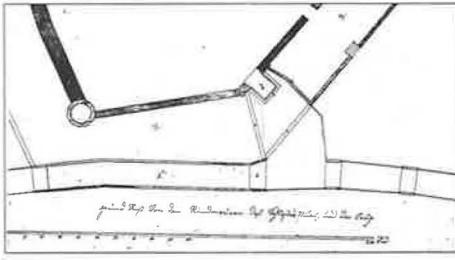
Ausschnitt aus einem Grundrissplan vermutlich Mitte 18. Jahrhundert, Ostseite des Schlosses. In der Bildmitte kleines Rechteck, versehen mit Nummer 7, nach der Bildlegende: «Die Ziehbrugg vor der Schlosspforte». Rechts davon vorgelagert die Ufermauer der Grossen Zühl und ein Teil der grossen Zugbrücke.
